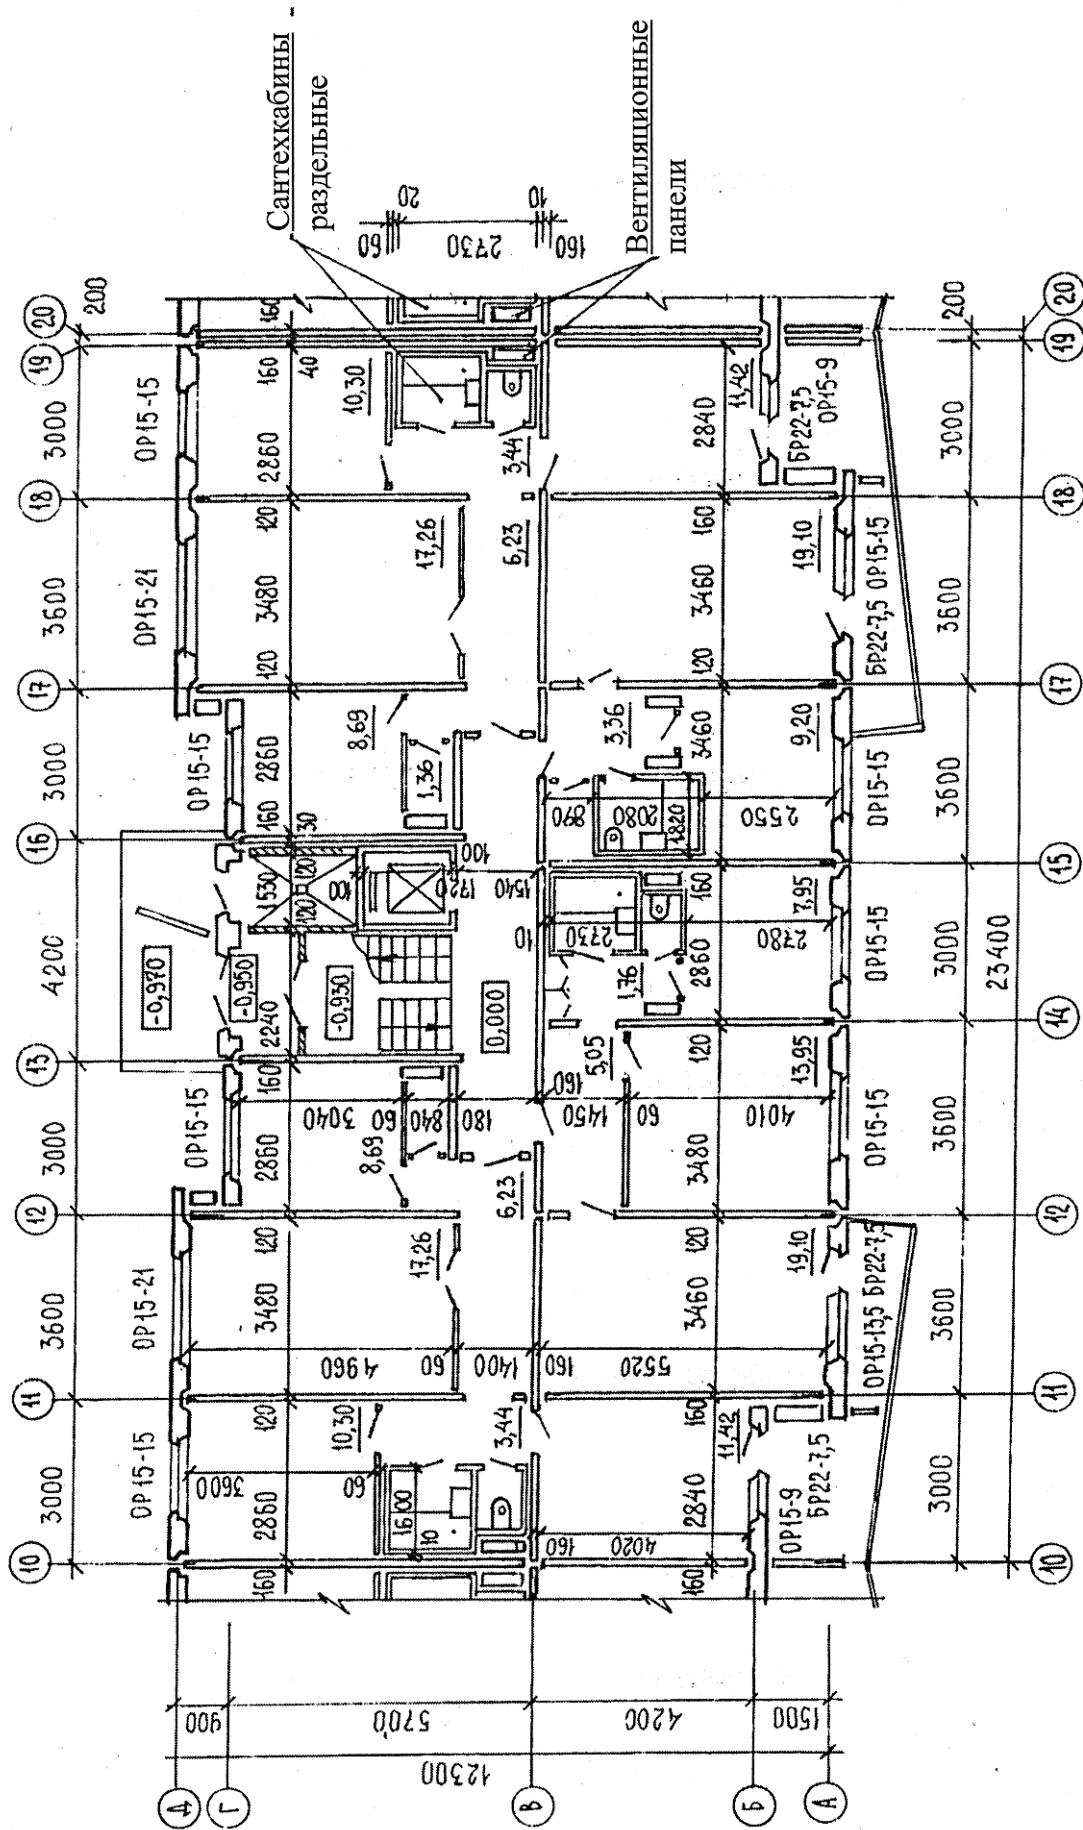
План первого этажа жилого девятиэтажного дома. Перекрестно-стенная конструктивная система с малым шагом поперечных стен (серия 111.90)
